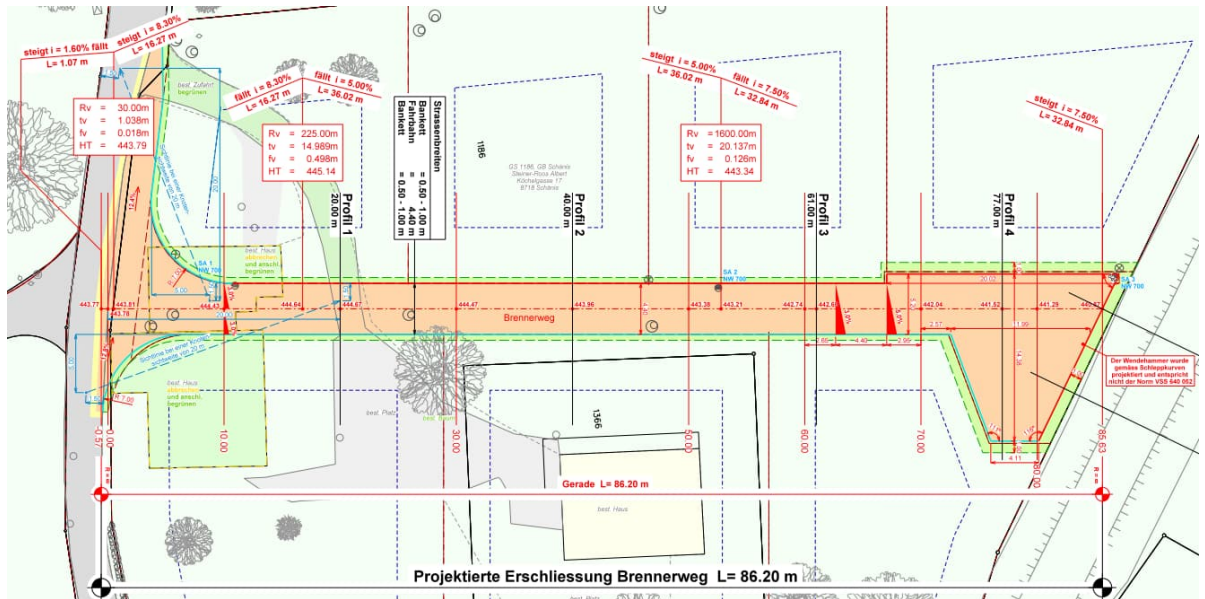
Ausschnitt Situation Erschliessungsstrasse, Plan Nr. 1331 03.04-1
